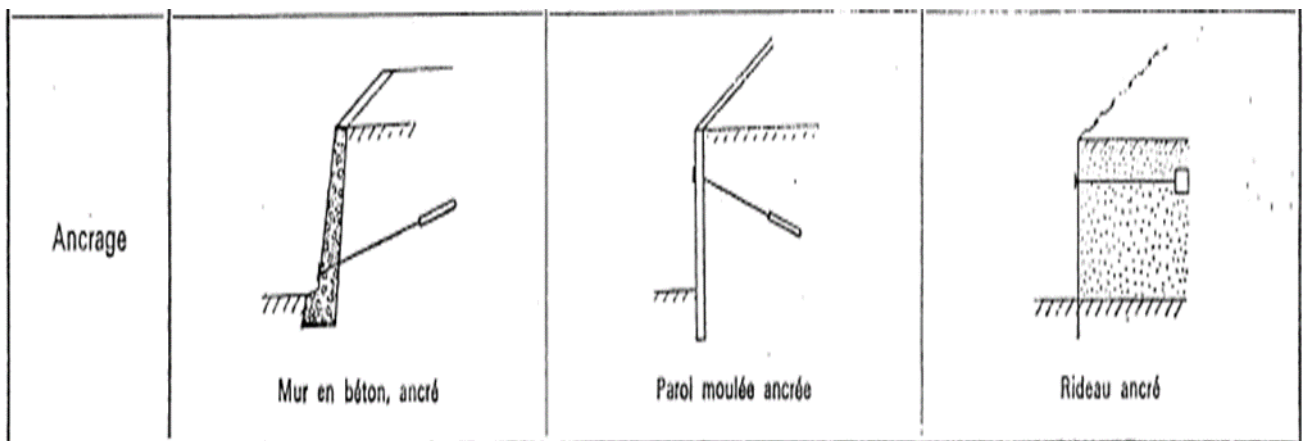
Ouvrages de soutènement reprenant en totalité ou en partie la poussée par leur ancrage dans le massif retenu ou dans le sol de fondation
